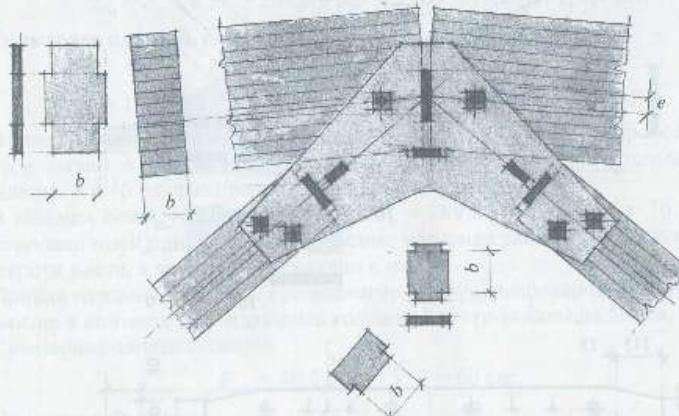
Вариант узла Е безметаллической фермы (а) и стык нижнего пояса (б)
